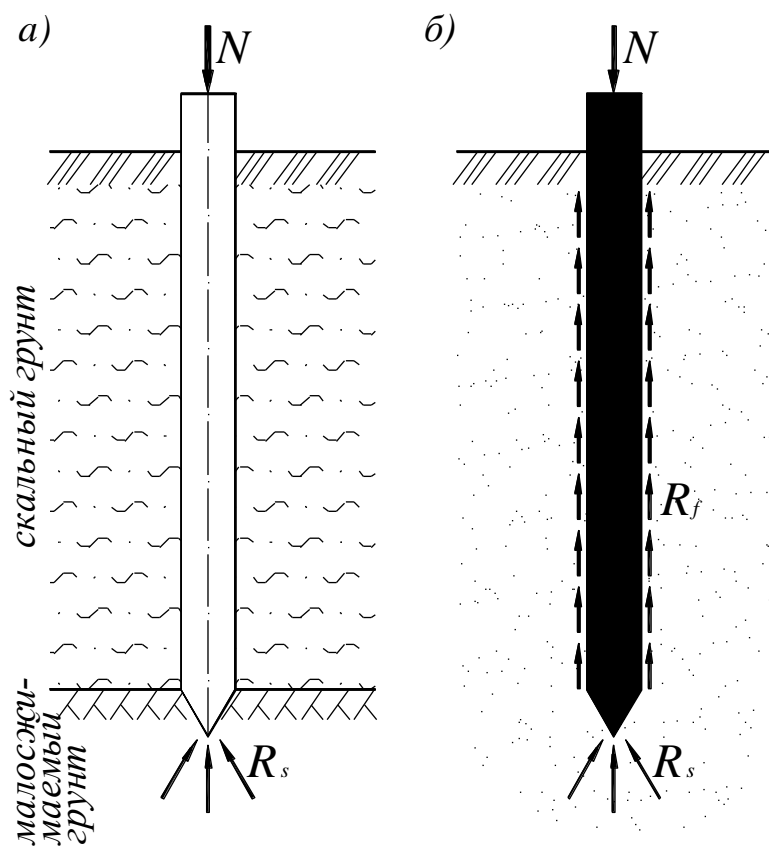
Схемы передачи нагрузки сваями на грунты основания:
